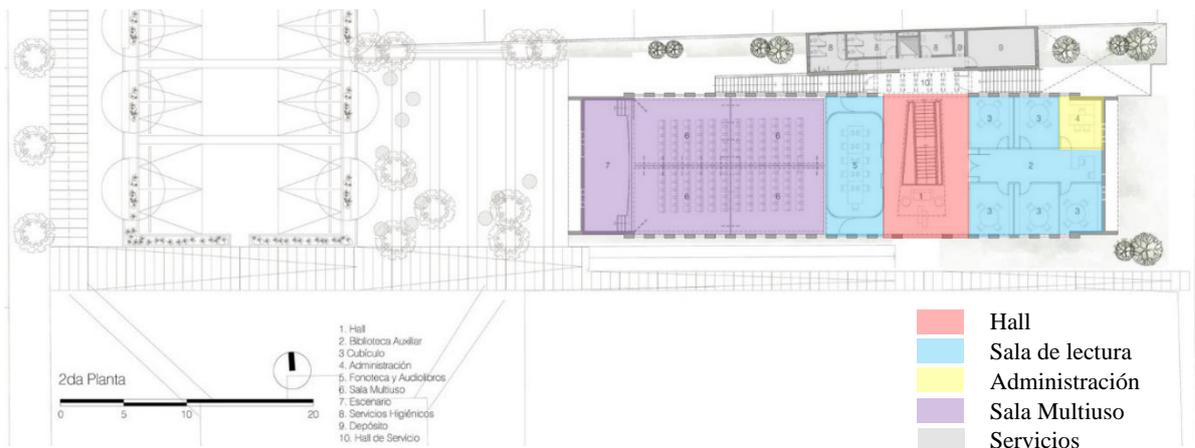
Plaza Biblioteca Sur - Segunda Planta.
